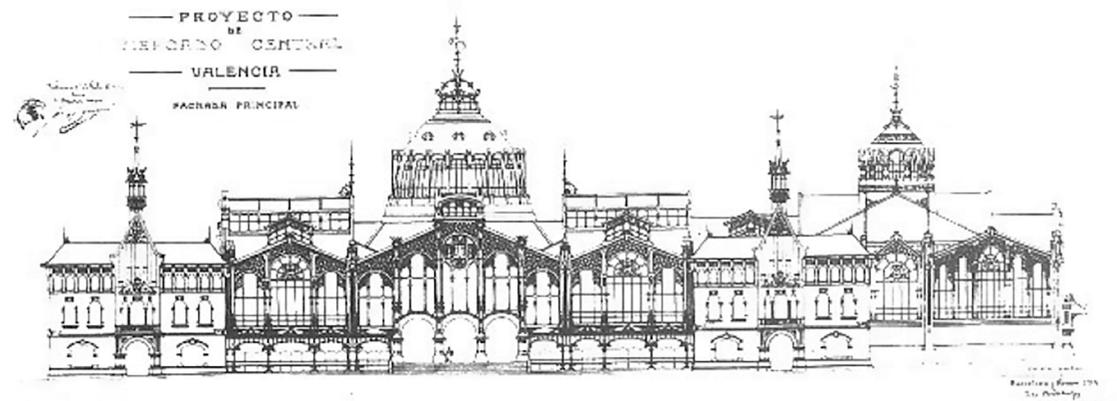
Alzado de la propuesta final para el Mercado Central
